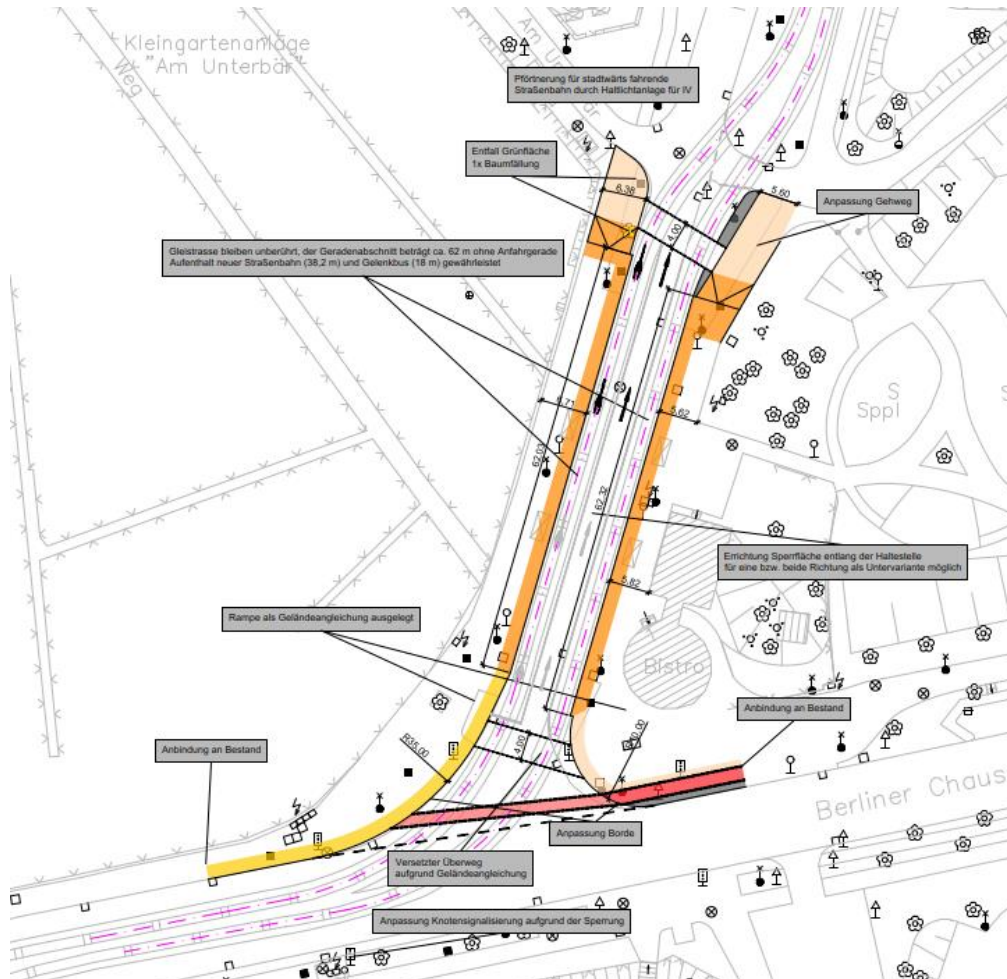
Lageplan Maßnahme I4 (Hauptvariante)
